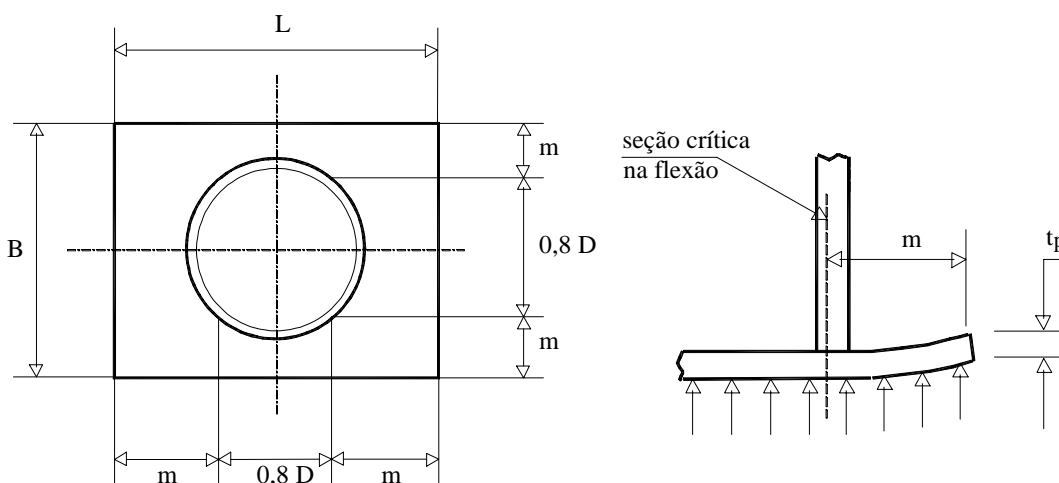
Detalhe seção crítica da viga em balanço e sua projeção de acordo com DEWOLF & RICKER.
